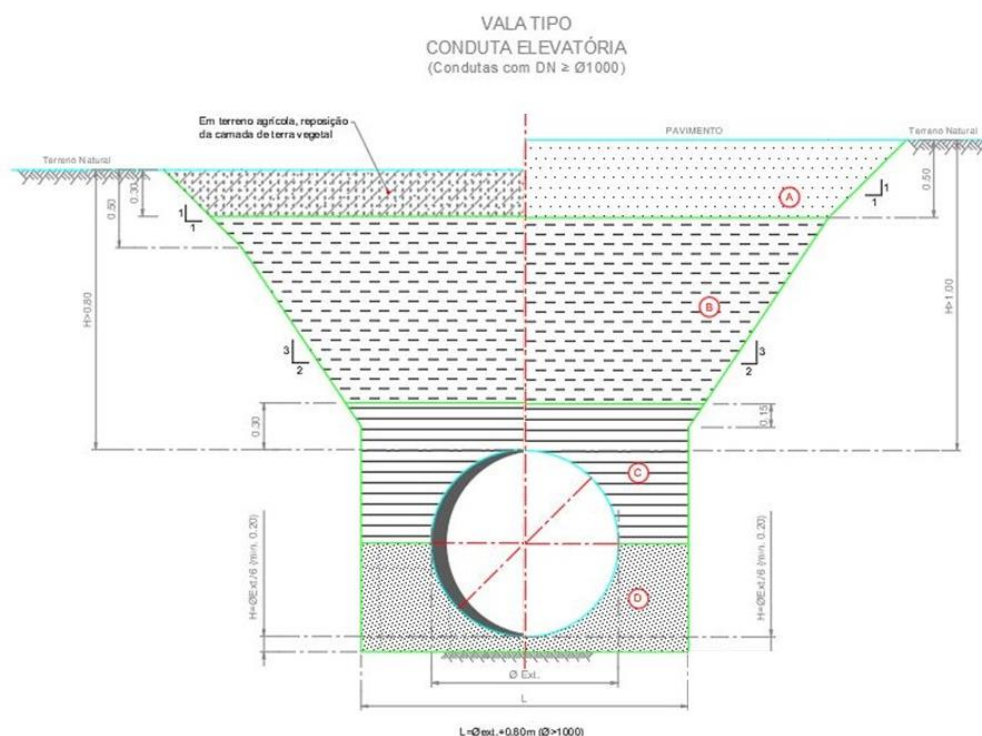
Condução Adutora Principal. Perfil tipo
